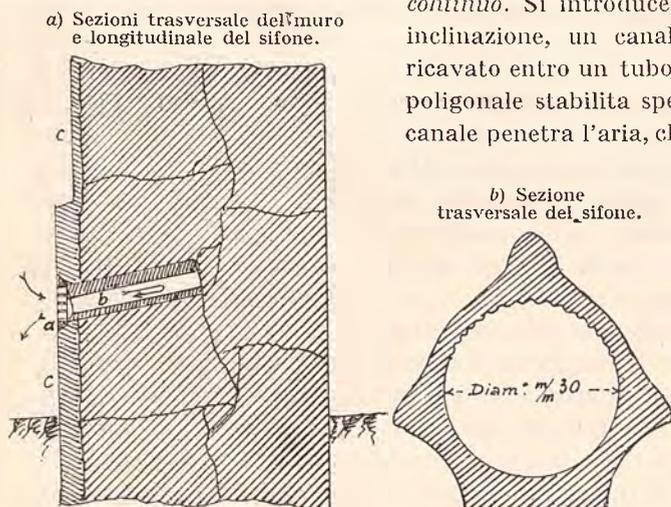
a, b. — Sezione trasversale di un sifone Knapen.
